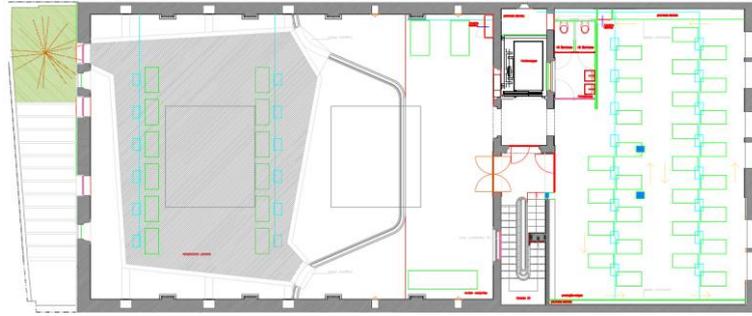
Planta do Piso 2 (Cota 108,64 m)
